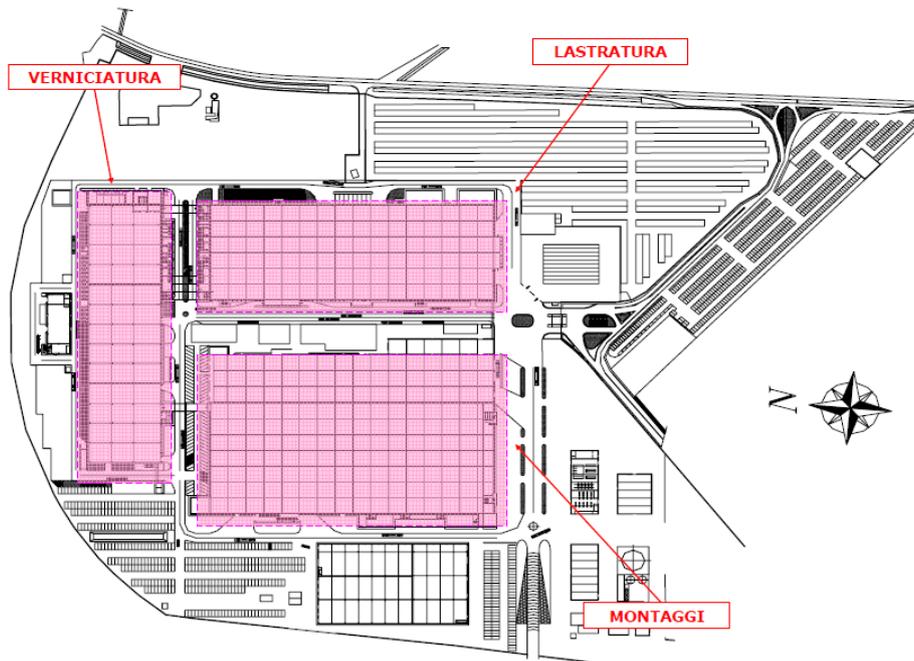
Planimetria plant 6, dettaglio edificio
